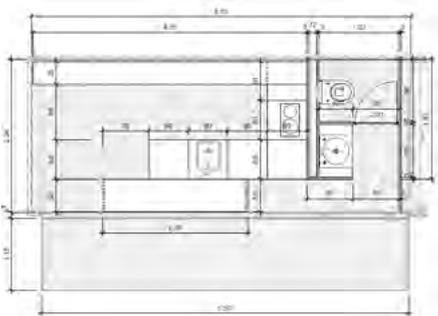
Grundriss Küchen-Bad-Modul
